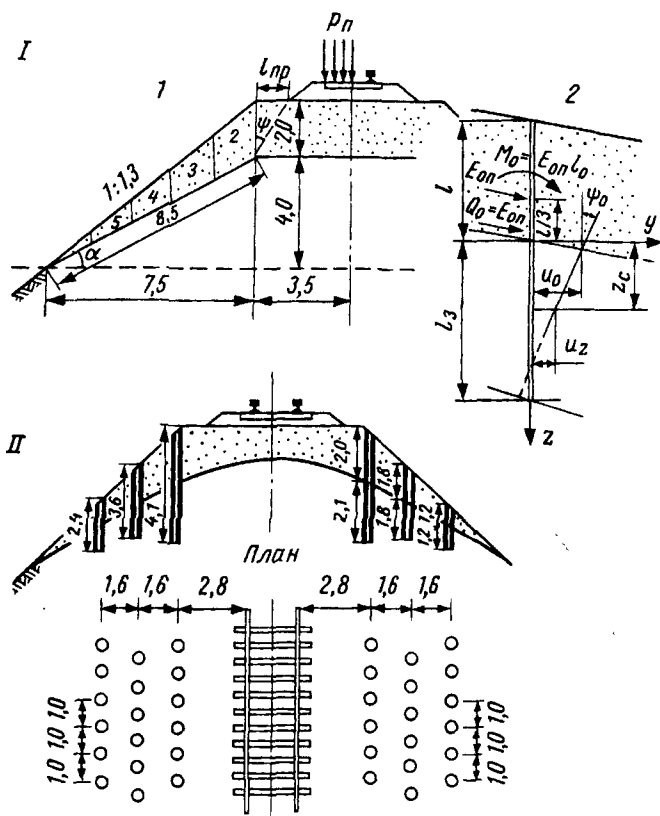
Схемы проектирования конструкции усиления насыпи буронекционными сваями. I — расчетные схемы: 1 — устойчивости балластного «шлейфа»; 2 — буронекционной сваи; II — конструкция усиления насыпи буронекционными сваями.
